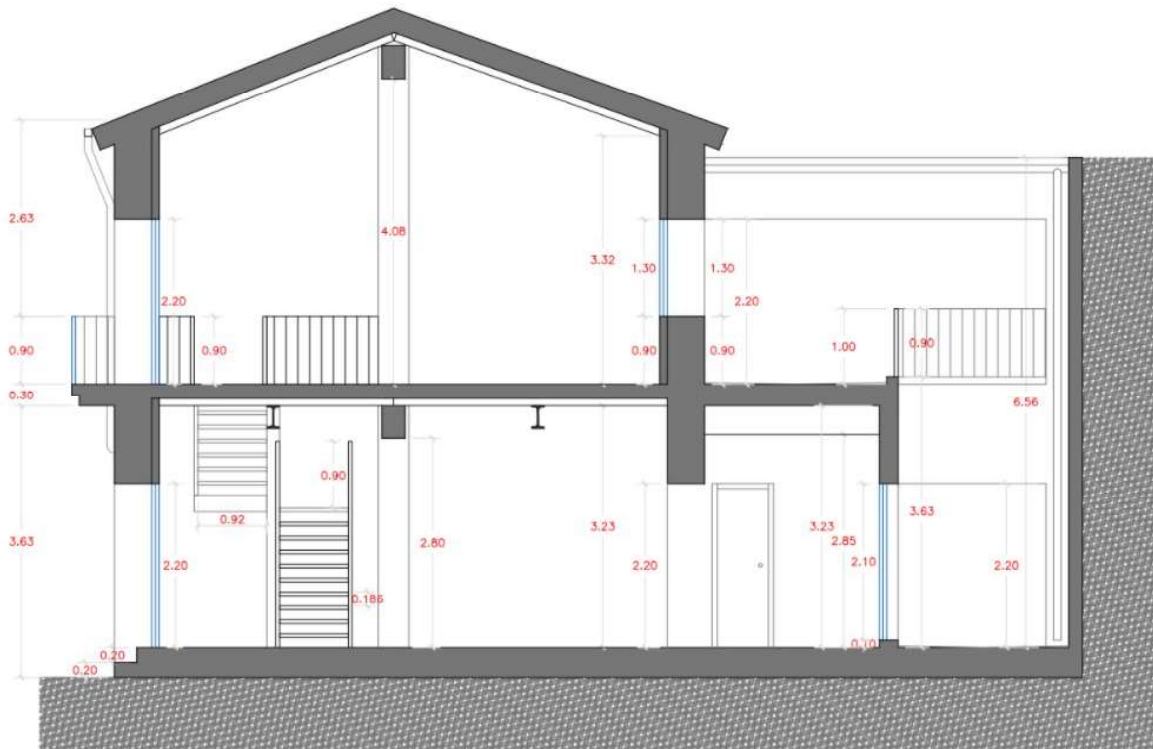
Sección I vivienda proyectada (proyecto básico)
